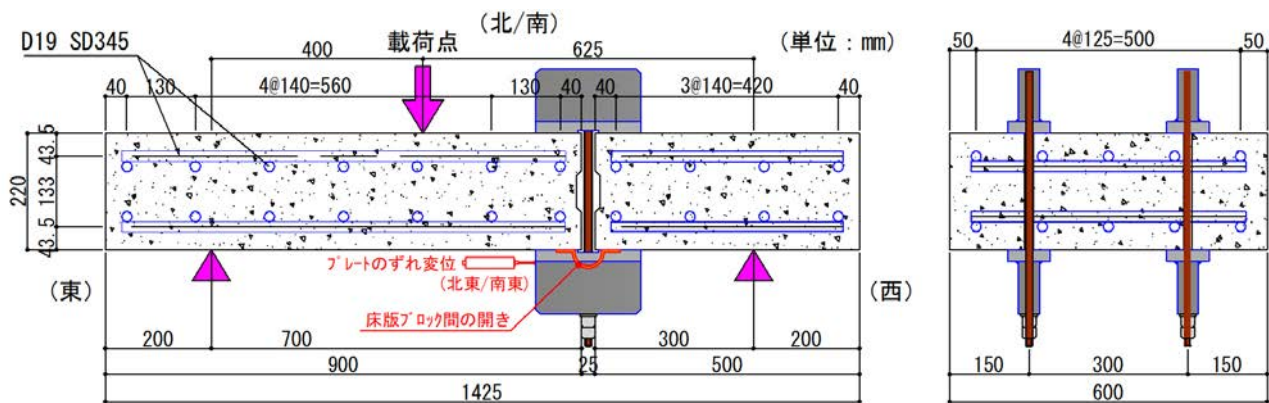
プレート型継手構造を有する梁の荷重試験体 (左：橋軸方向断面図, 右：橋軸直角方向断面図)
